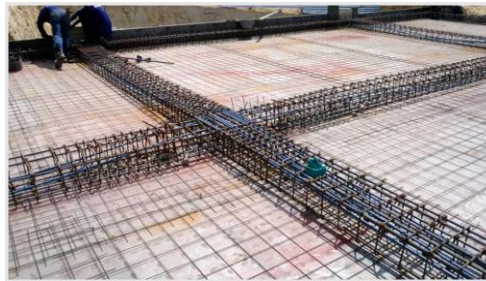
Sistema de placa de piso postensado. Fuente: 360 en concreto. Cortesia Oteco Ltda
